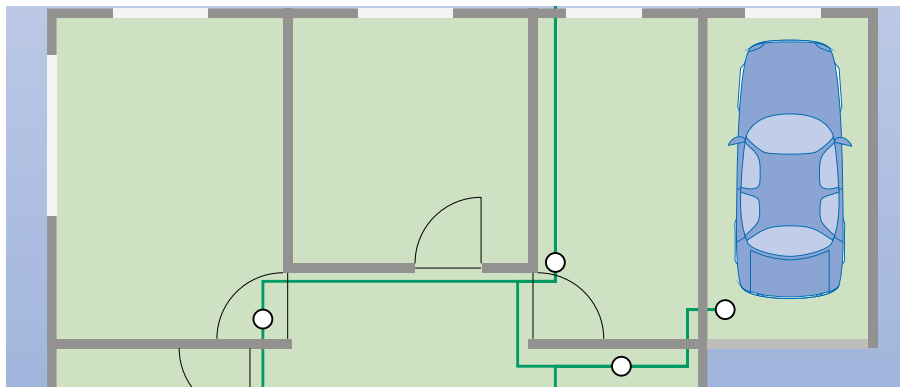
Grundriss (Quelle: KNX Association)
